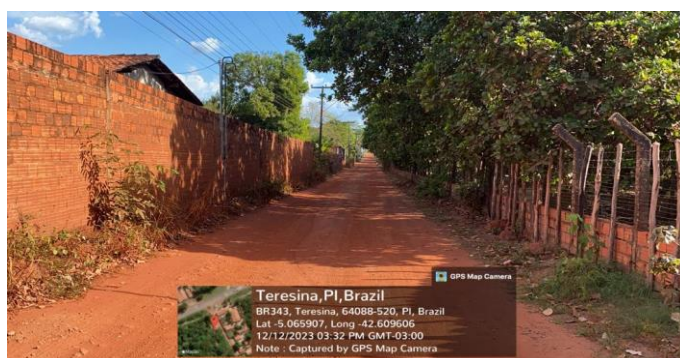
LOCAL DA PAVIMENTAÇÃO
